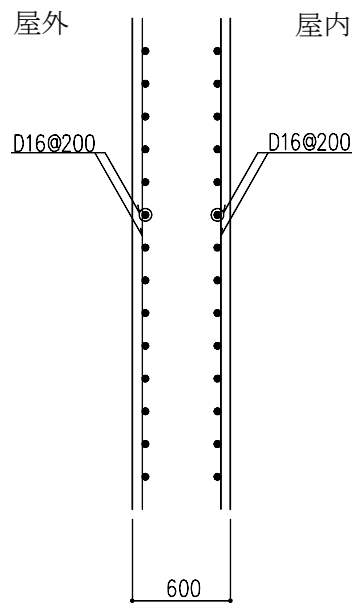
耐震壁の配筋図 (1階, YM通り X1~X2通り間) (単位: mm)
